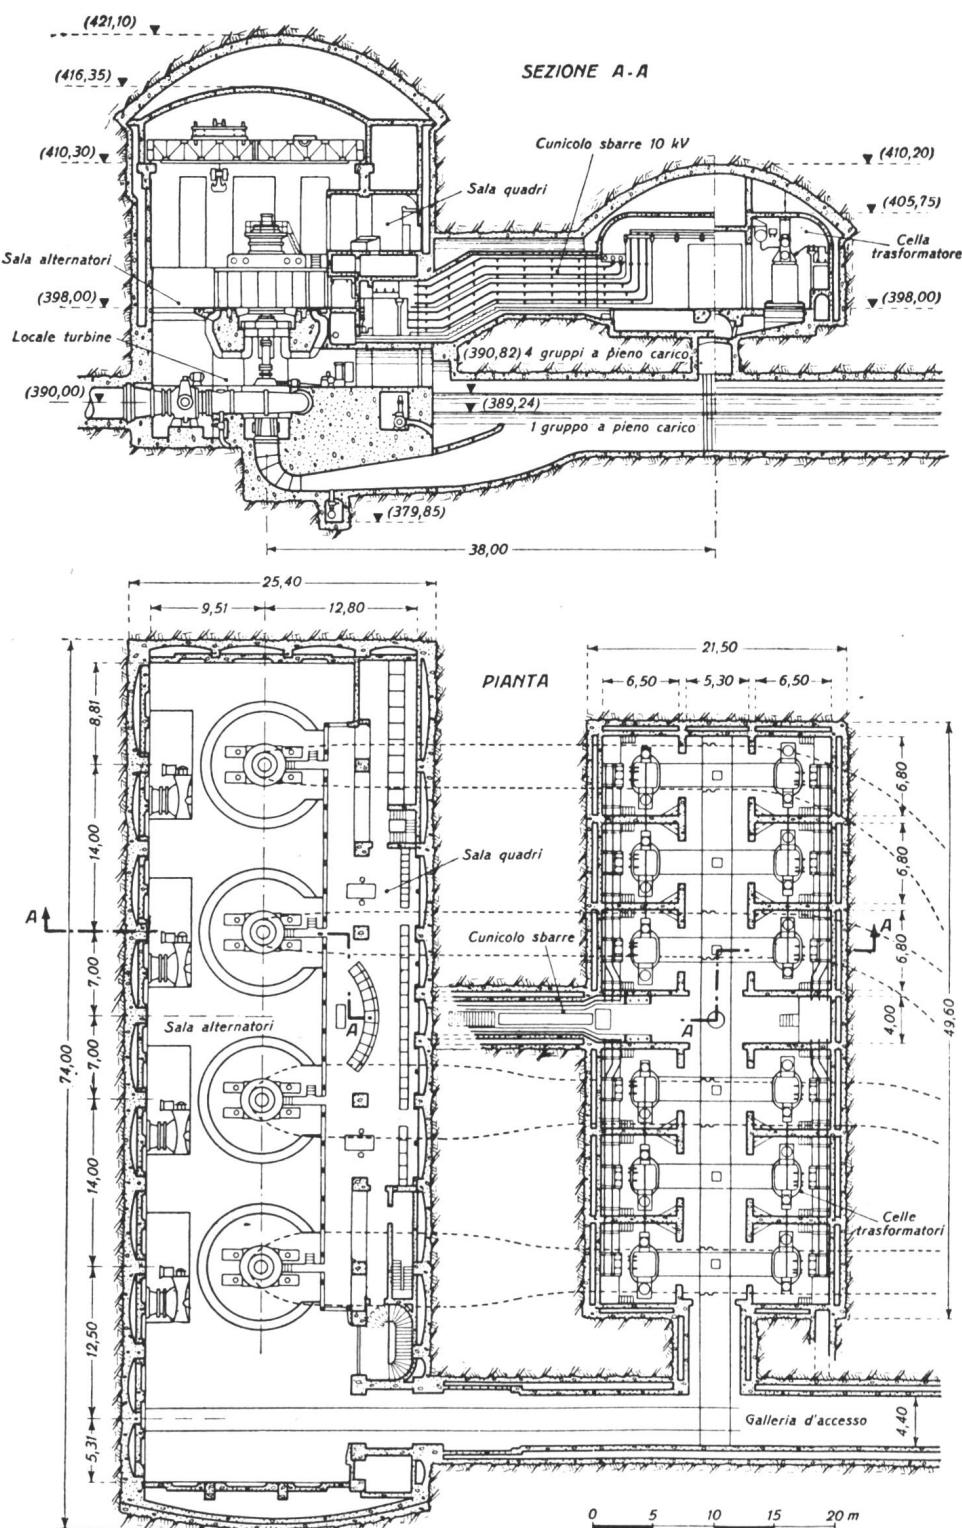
Kavernenzentrale «Achille-Gaggia / Soverzene», Querschnitt und Lageplan
